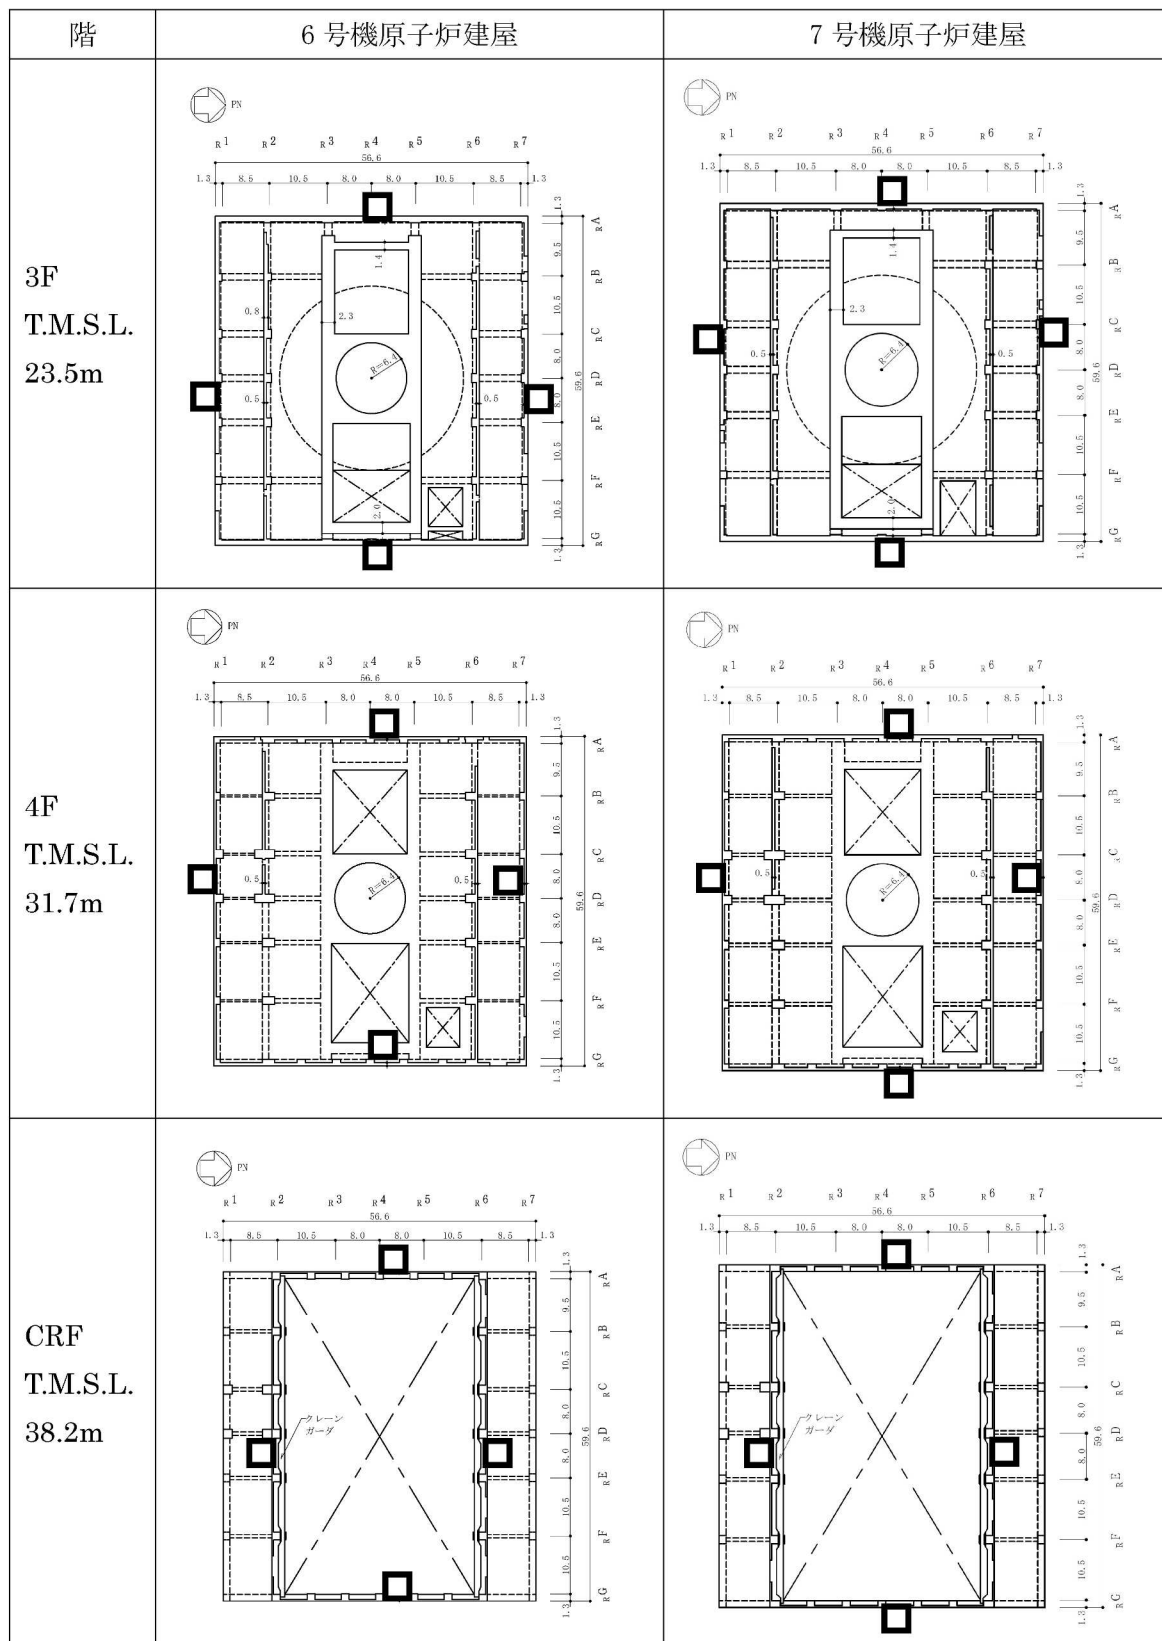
6号機原子炉建屋及び7号機原子炉建屋の概略平面図(4/4)(単位:m)
